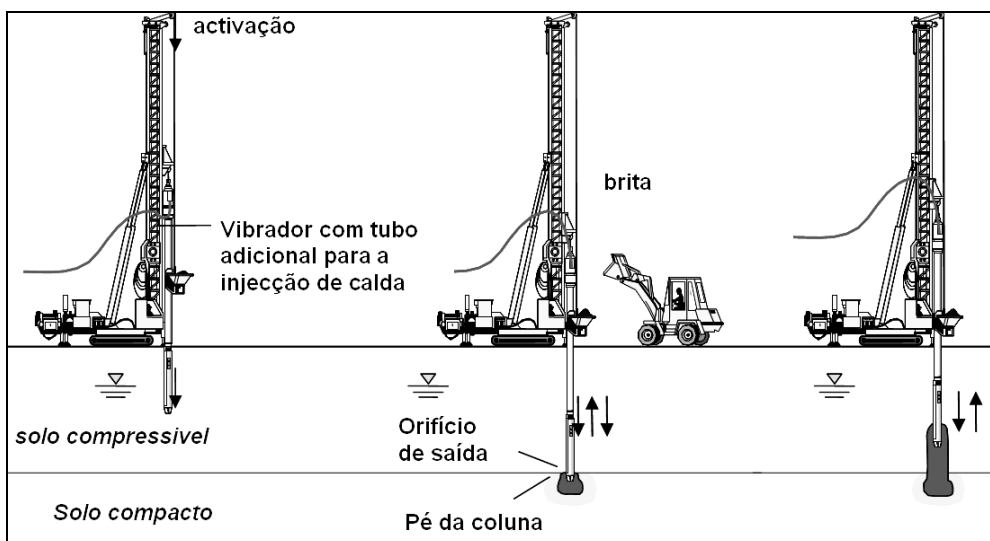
Esquema de execução das Colunas de Brita Injectadas
